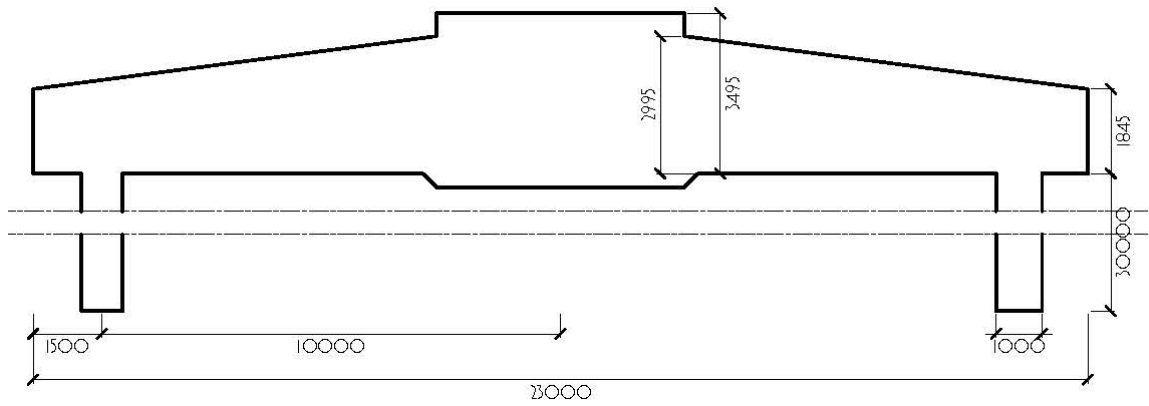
FIGURA II: GEOMETRIA FONDAZIONE INDIRETTA
